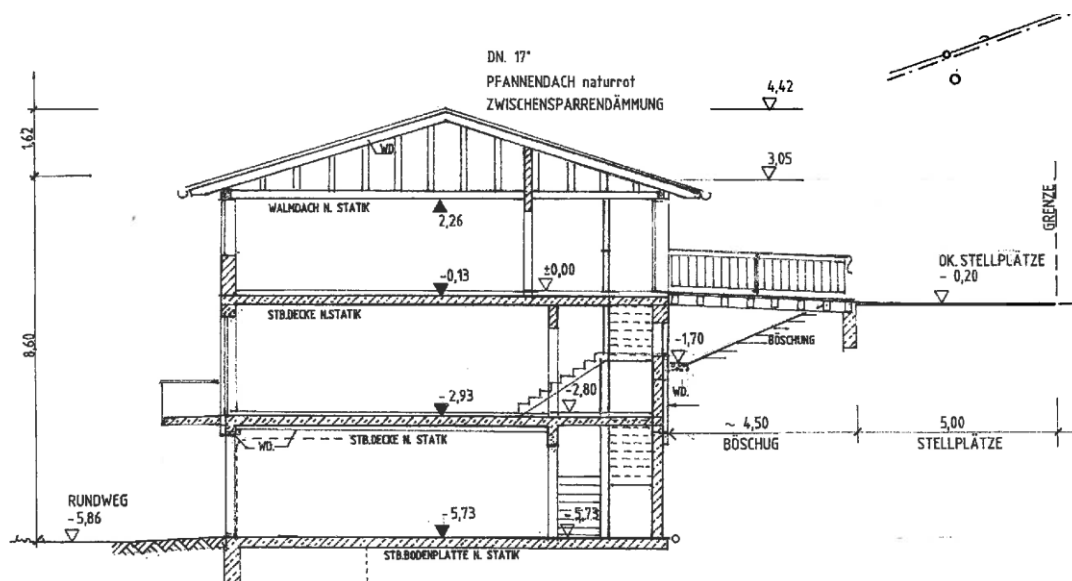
Absolute maximale Wandhöhen tal- und straßenseitig, Auszug aus dem Entwurf Architekturbüro Peter Bauhofer
